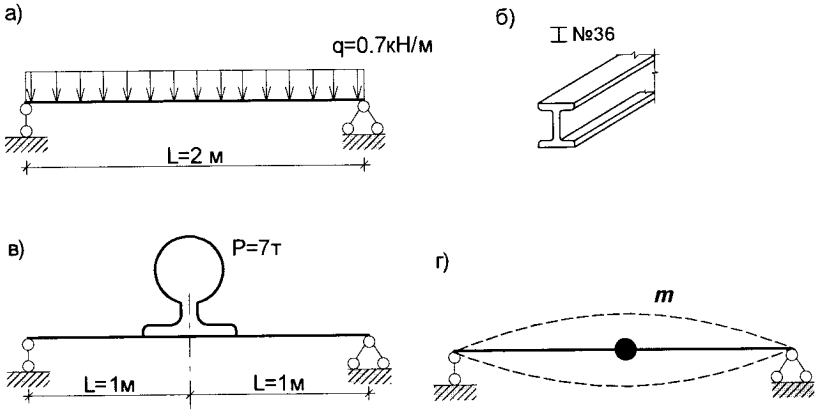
а) схема балки; б) поперечний переріз балки; в) схема установлення електромотора; г) динамічна розрахункова схема балки
